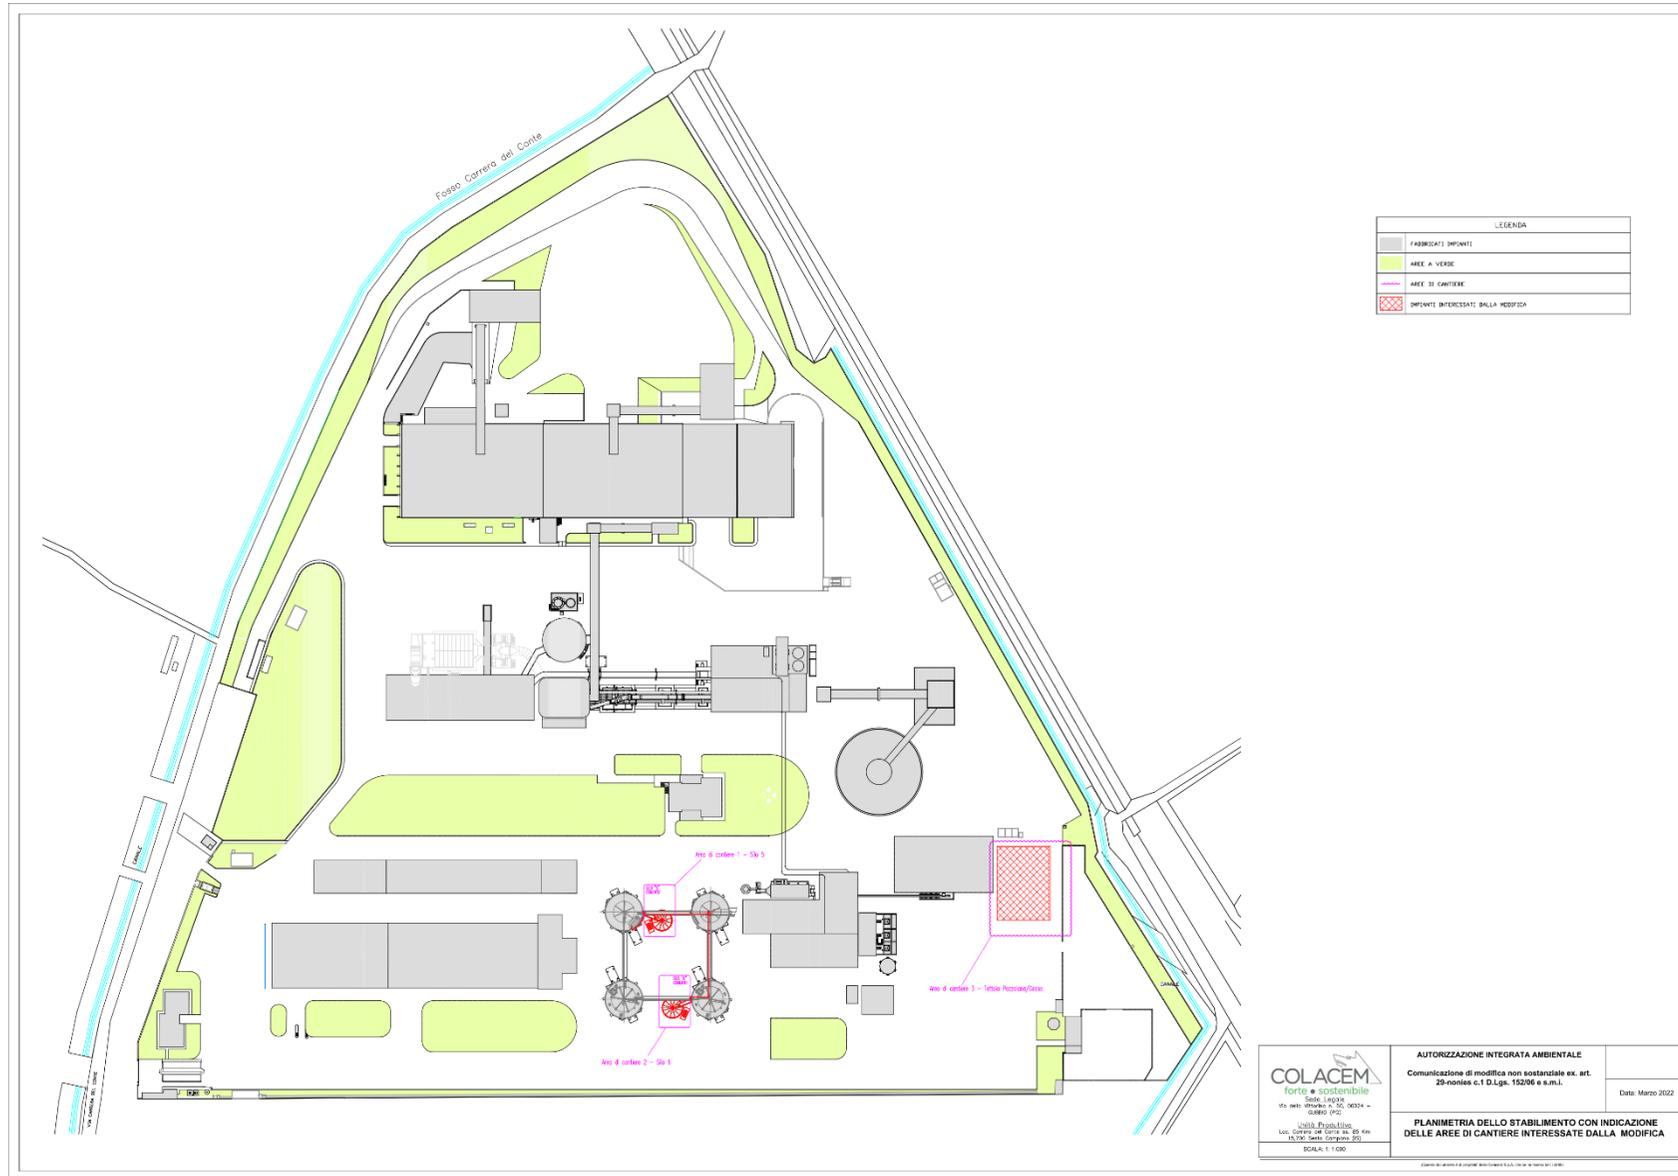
planimetria generale dell'installazione con indicazione degli impianti interessati dalle modifiche progettuali e delle aree di cantiere
